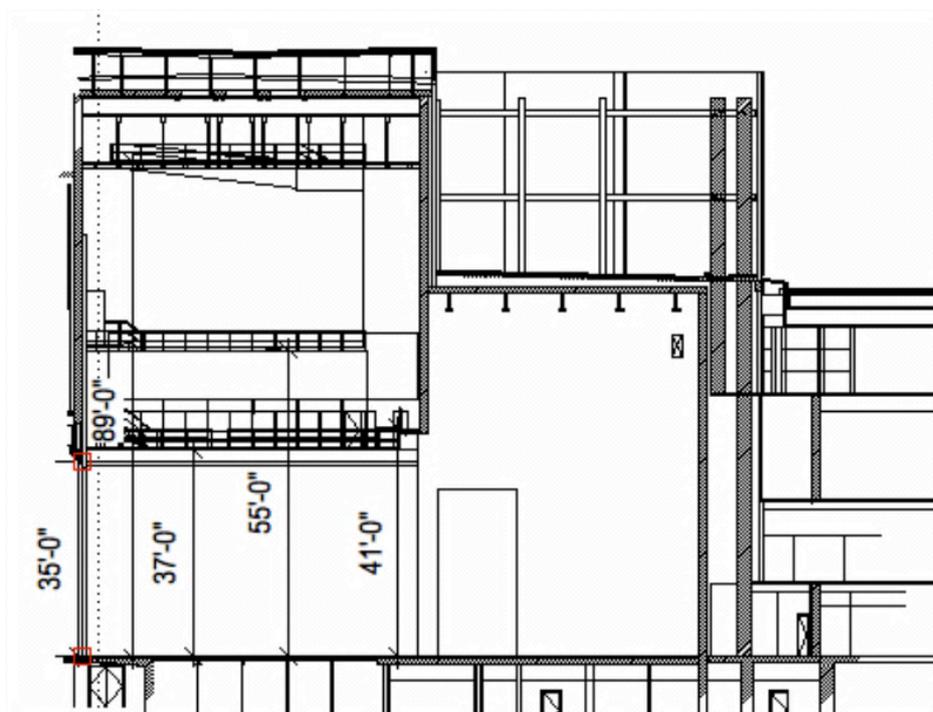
Corte do palco. (FONTE: ATTPAC,2012. NOTA: dimensões em pés)
